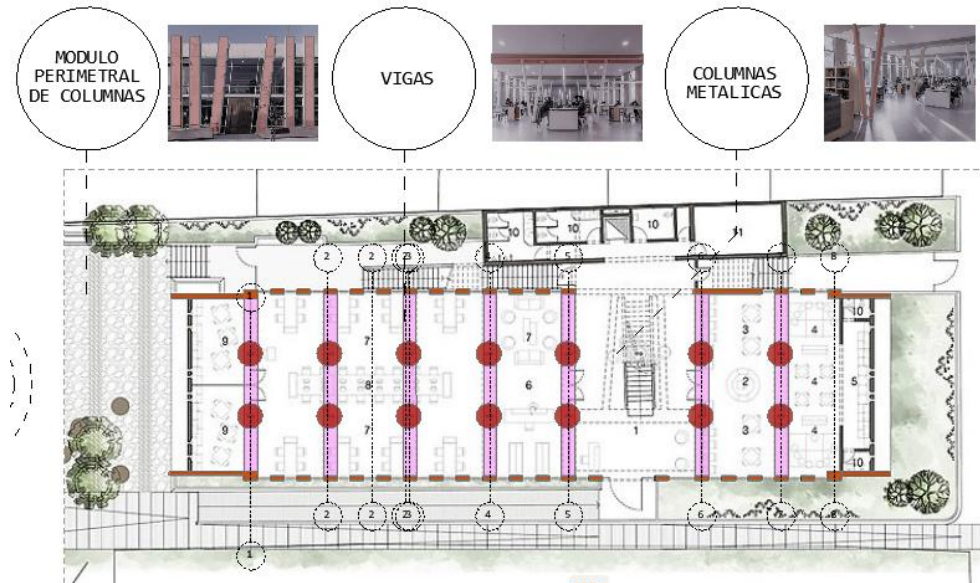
Biblioteca la molina. Adaptado de plataforma arquitectónica.
